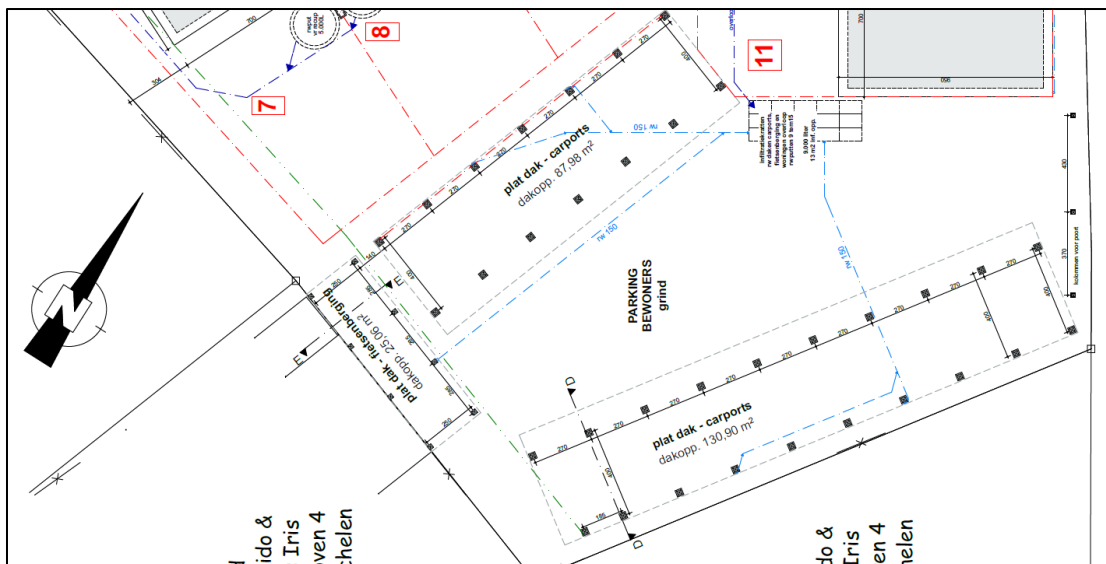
detail van de carportfundering © architect N. Cornelissen
